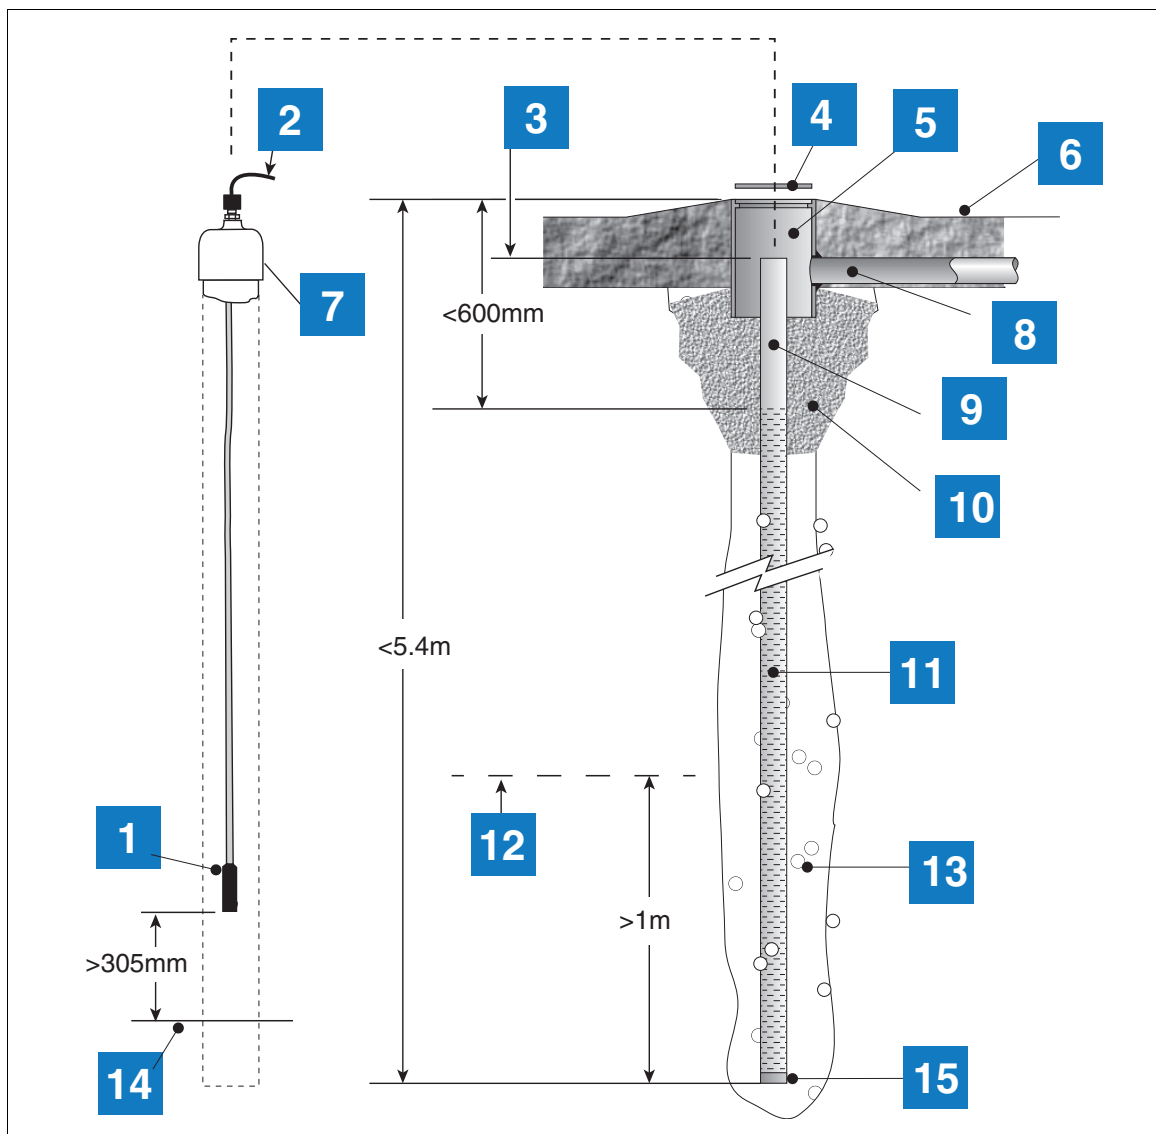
Section transversale au travers d'un exemple d'installation de capteur de vapeur
